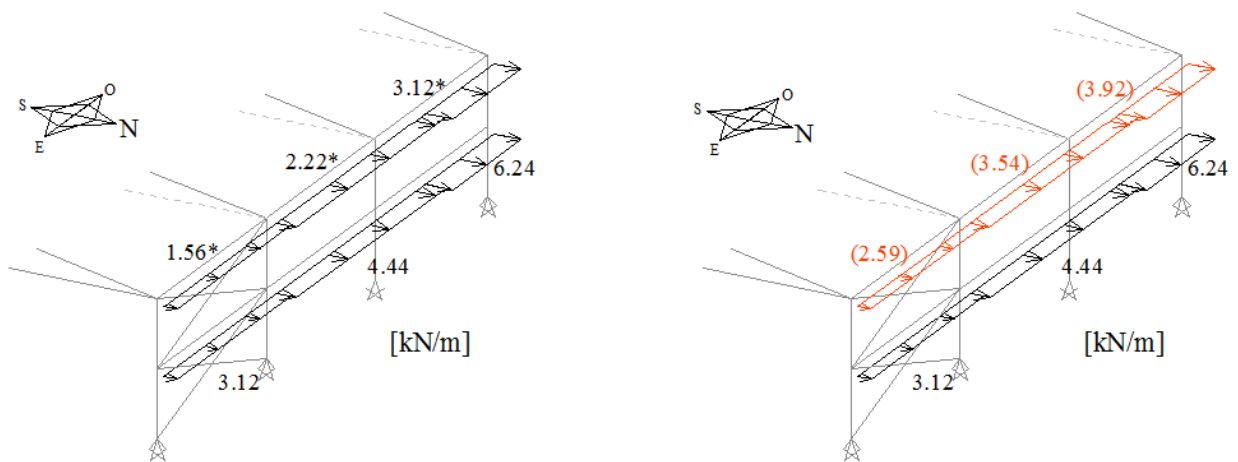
Vento W2 na fachada orientada a Norte na situação 1 (EC1.1.4)
